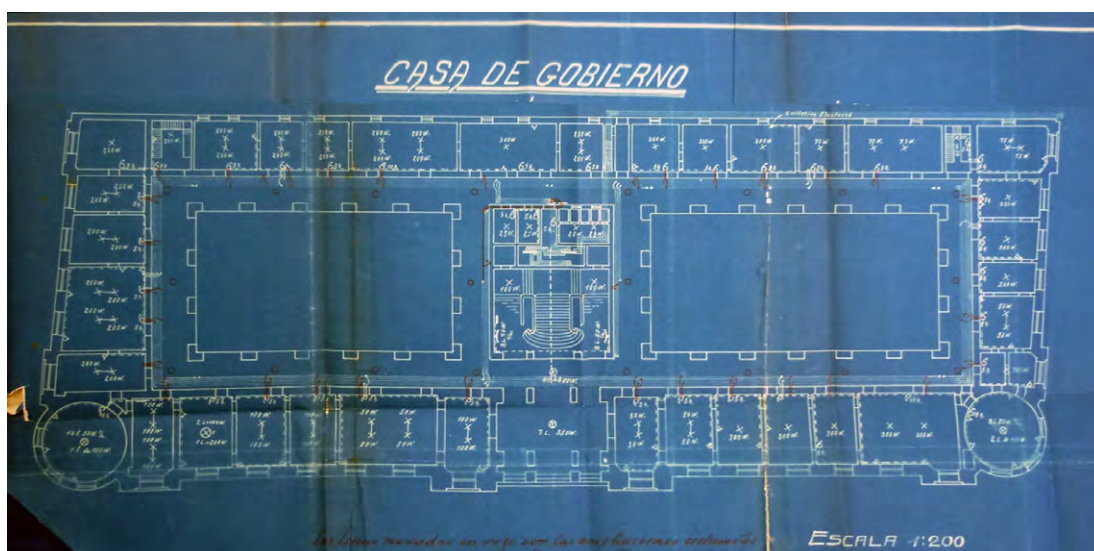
Planta baja Casa de Gobierno, proyecto definitivo (1910). Archivo MOP, Departamento La Capital, AGPSF.
